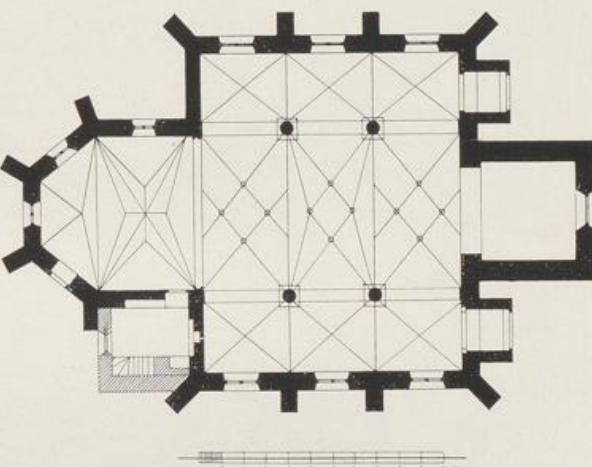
Nörvenich. Grundriss der kathol. Pfarrkirche.
